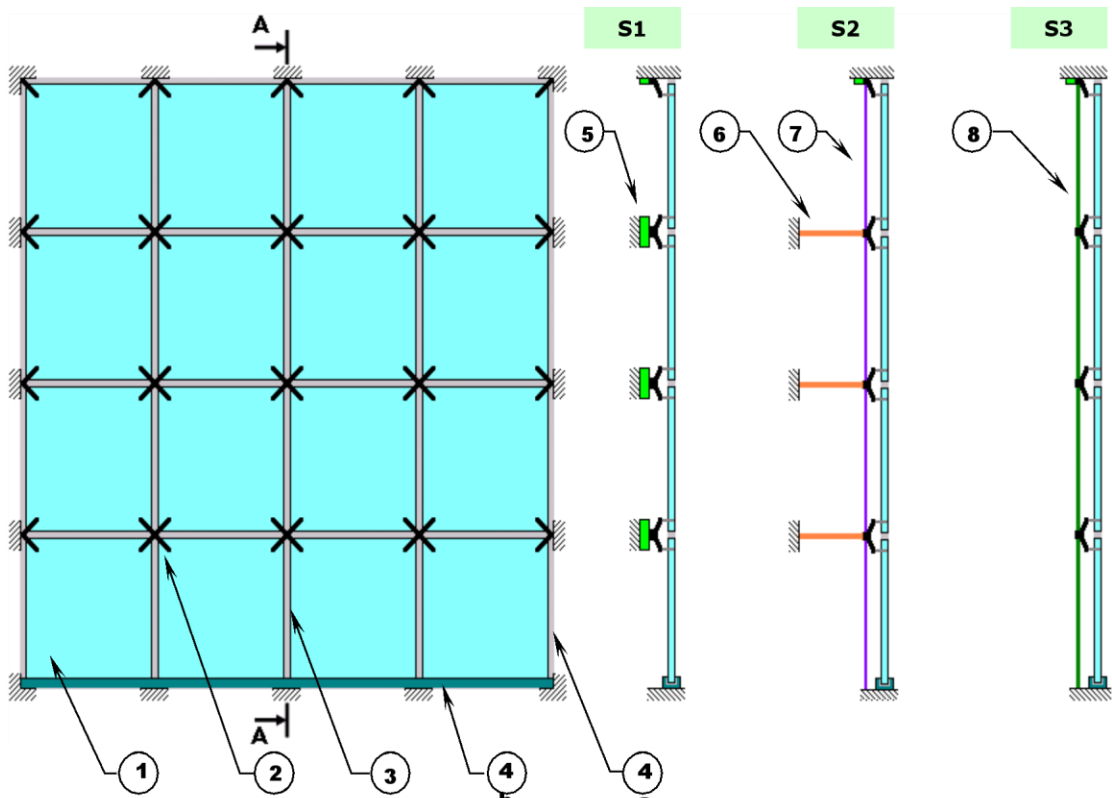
Joints courants d'étanchéité entre simples vitrages VECAFIX™-S et POINT S
